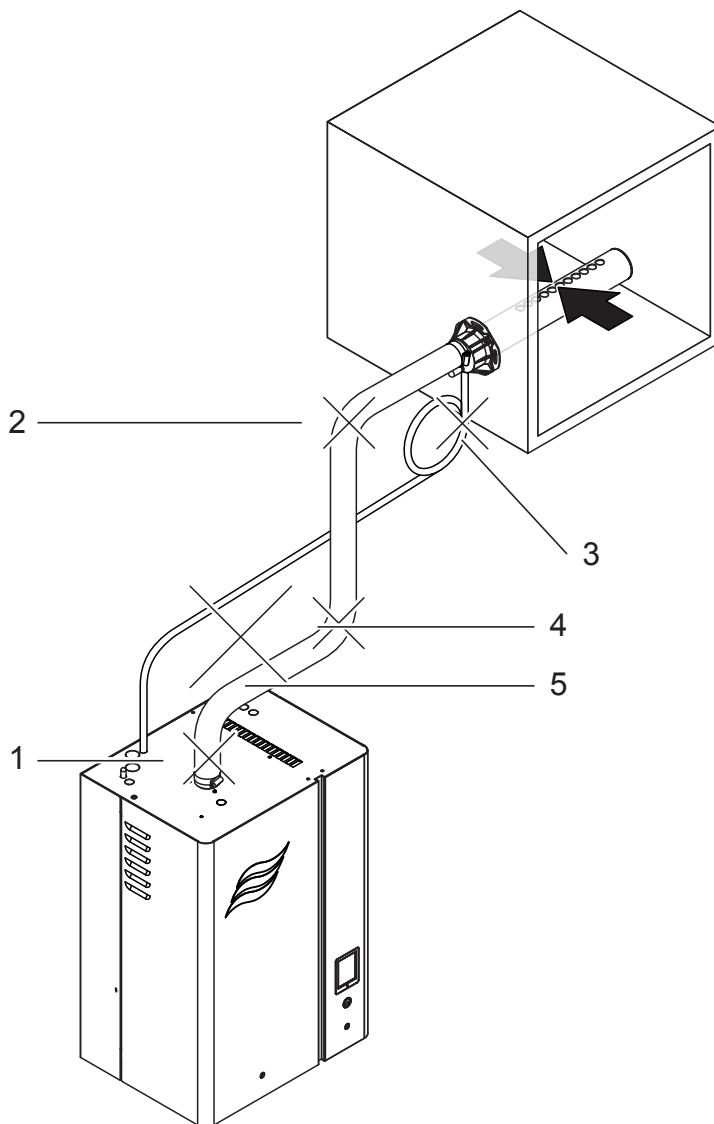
Tubería de vapor con tubos rígidos y aislamiento
